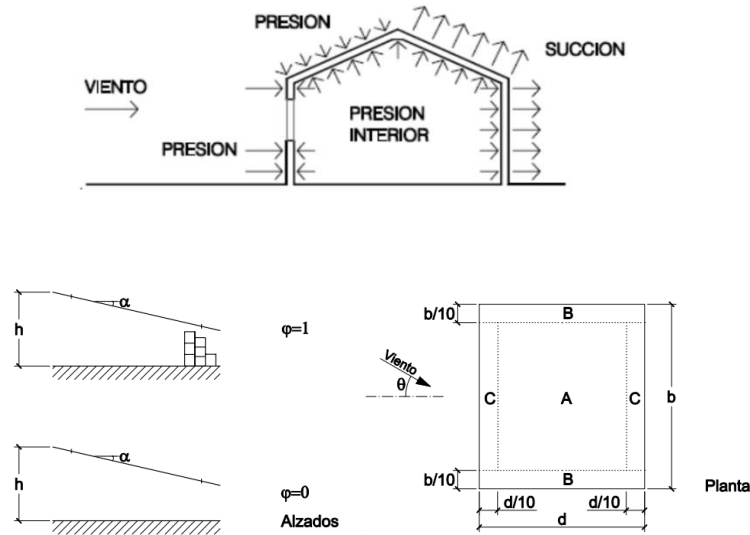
Marquesina a un agua (estructura tipo cubierta sobre plano horizontal). Fuente: CTE.
